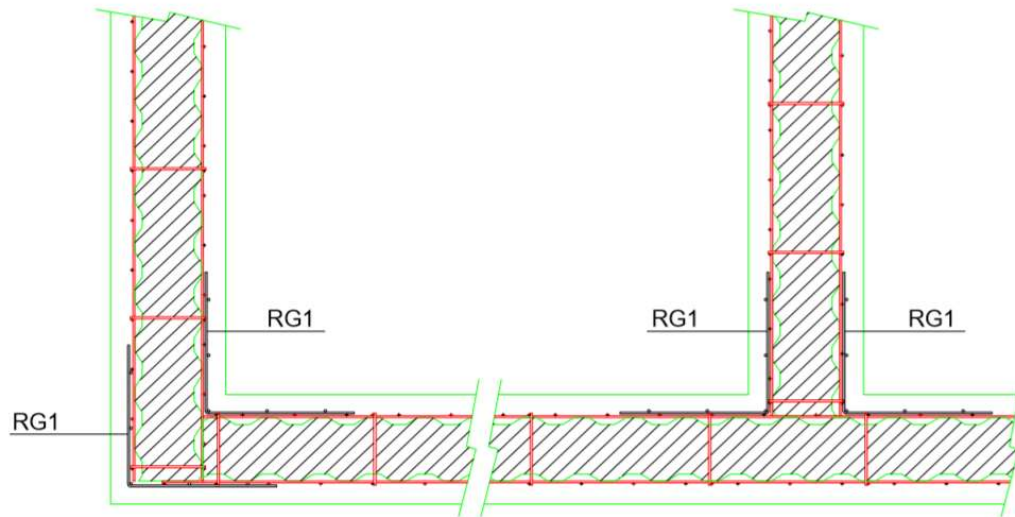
Colocación de malla RG1, vista en planta - Emmedue, 2008.
